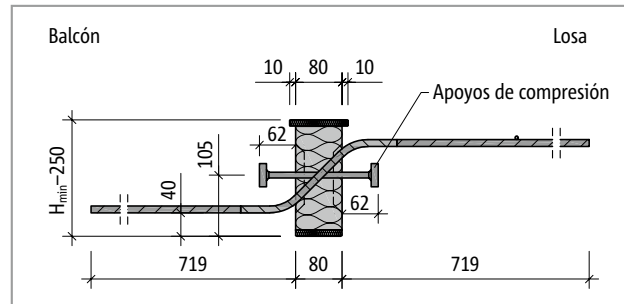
Schöck Isokorb® T tipo Q-P-V6: Sección del producto
